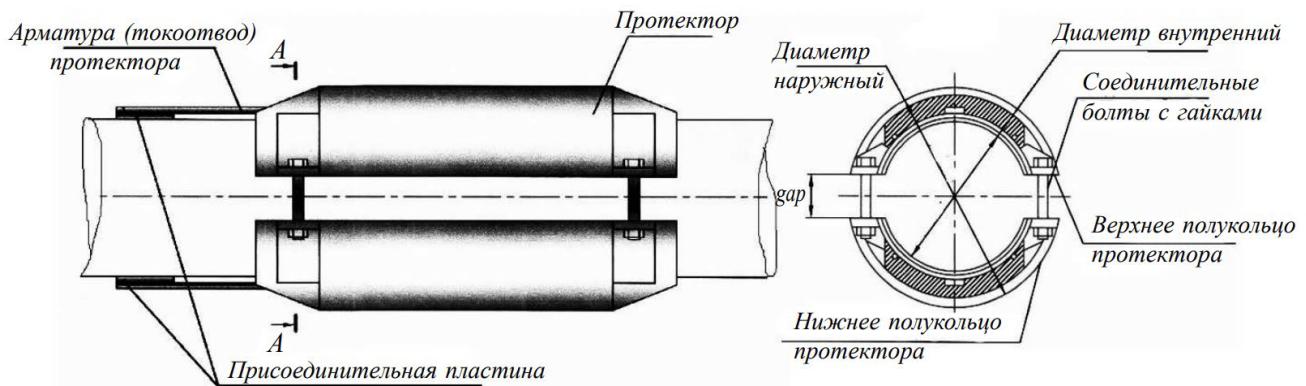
Схема установки протектора на необетонированный трубопровод
